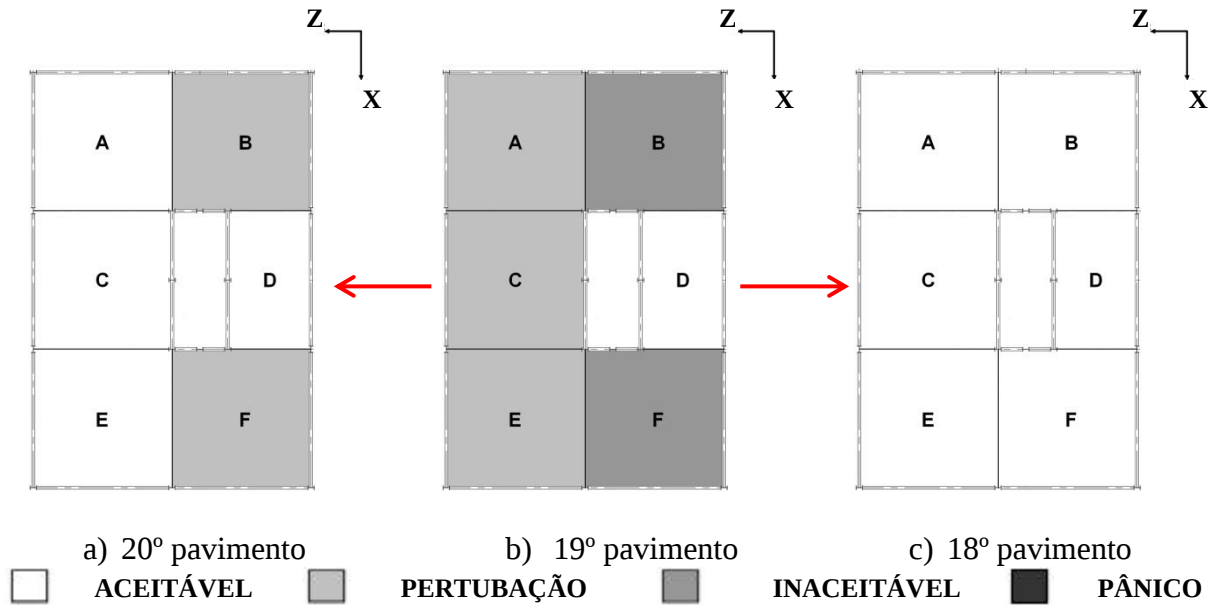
Percepção da vibração no 19° pavimento e pavimentos vizinhos devido ao MC-I: aeróbica
